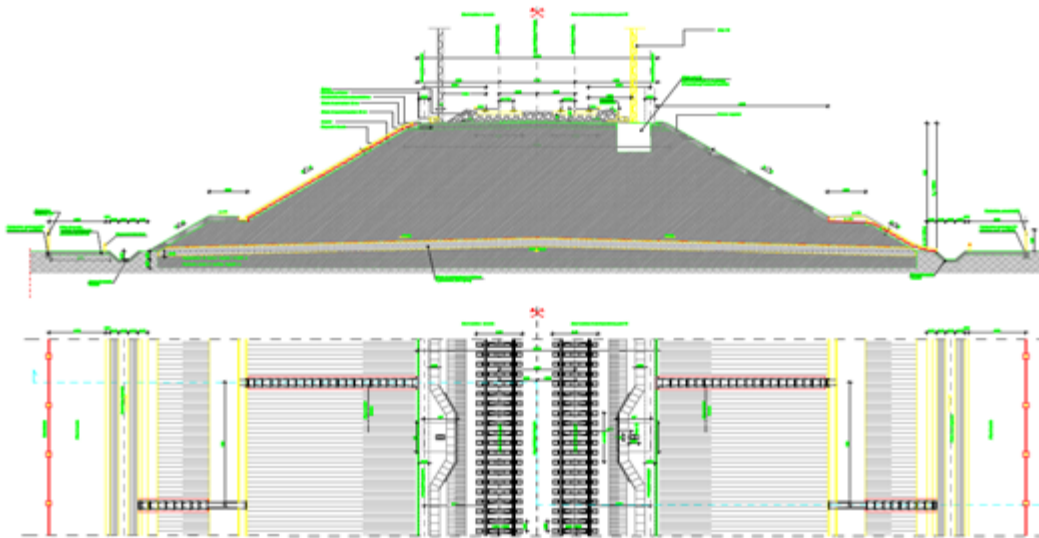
Sezione ferroviaria in rilevato a doppia linea
